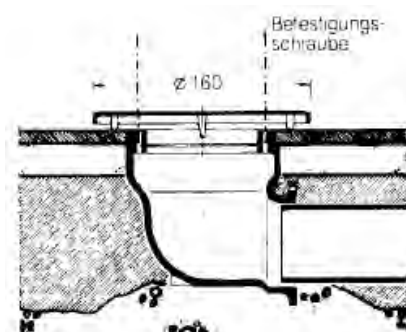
Anschluss des Bodenablaufes an eine Betondecke
